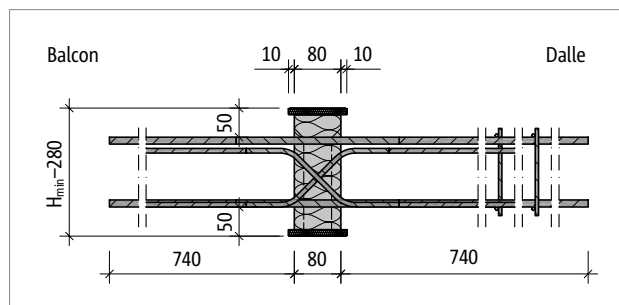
Schöck Isokorb® T types D-MM1-VV1 à MM5-VV1 à CV50 : coupe du produit
